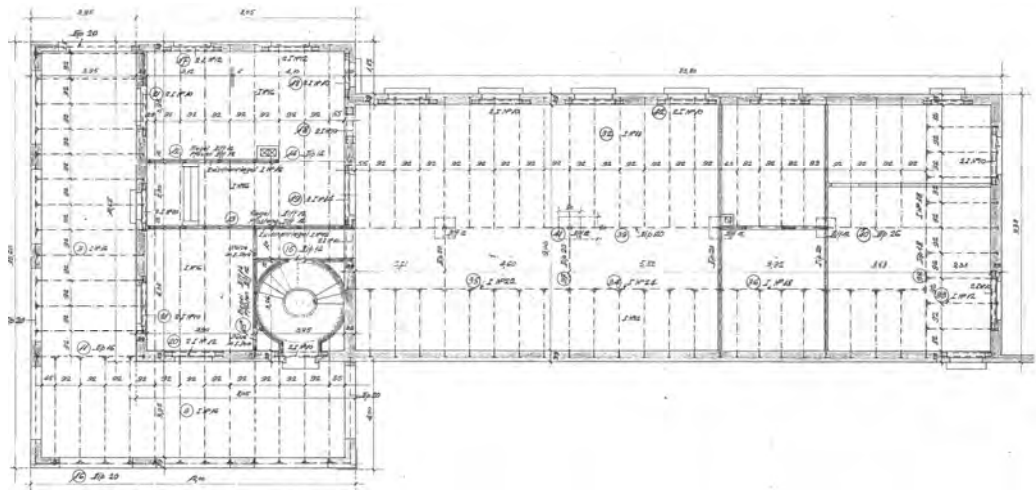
Grundriss EG, Bestandsplan
